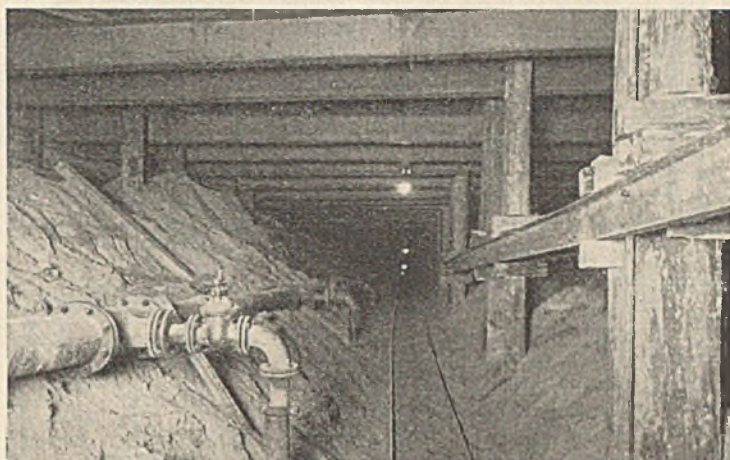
Deckenträger des Tunnels in vorläufiger Lage.
